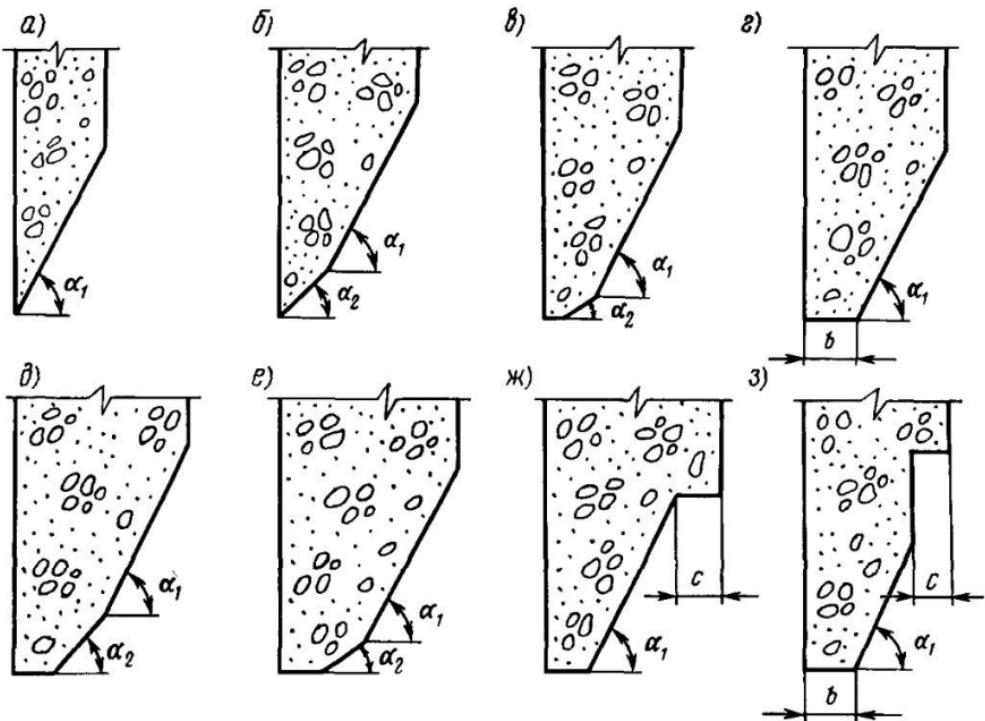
Схемы поперечного сечения ножа опускных колодцев
